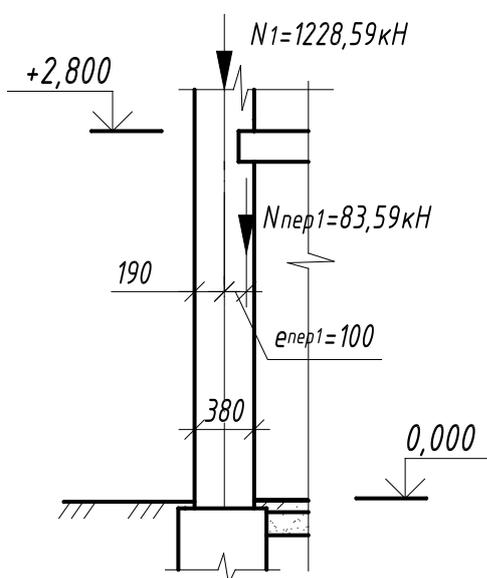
Расчётная схема простенка 1-го этажа
